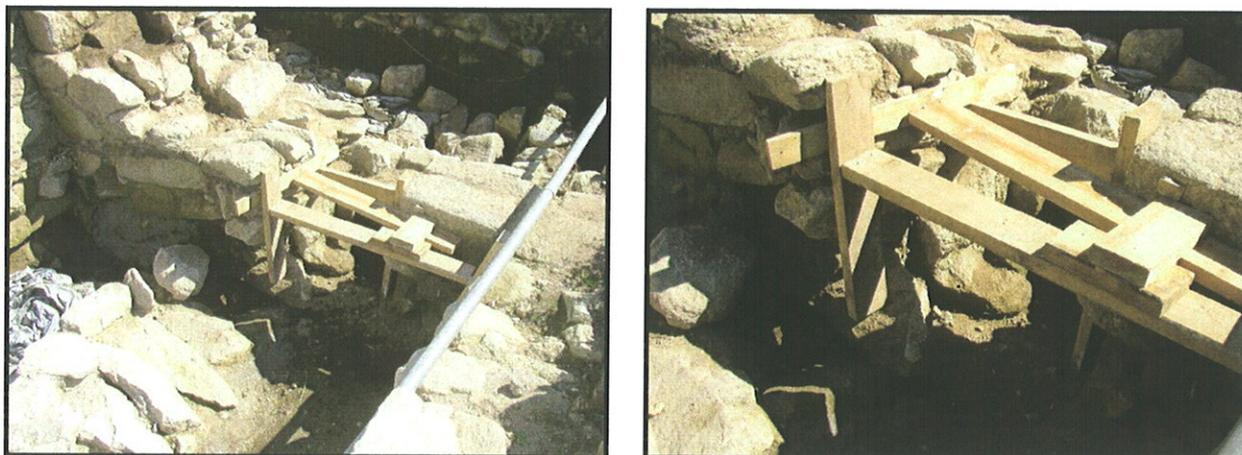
Detalles de apeo en tramo inferior M3a-M3b.
